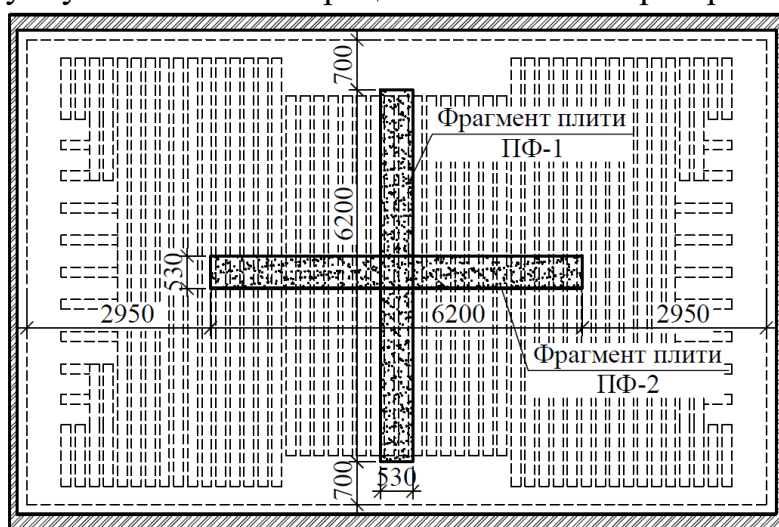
План розташування вставок у перекритті та вихідна конструкція фрагментів плит ПДФ-1 та ПДФ-2
